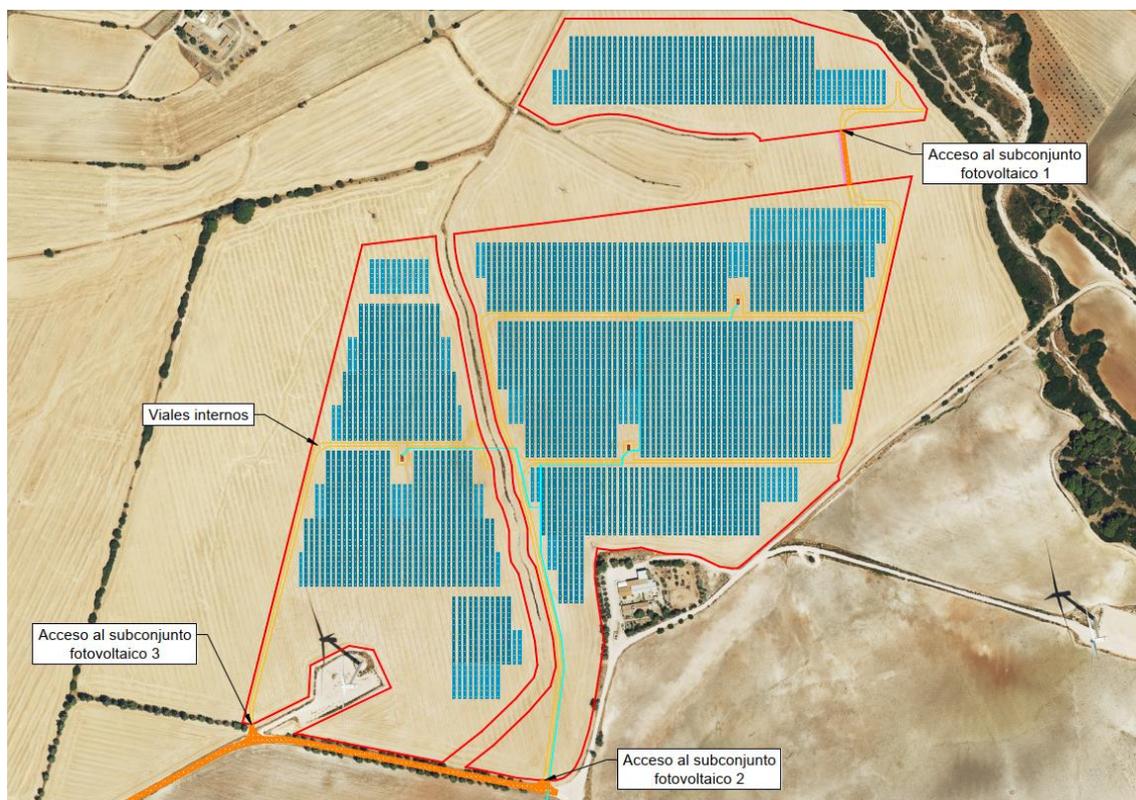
Detalle de acceso y caminos internos de la planta fotovoltaica.
